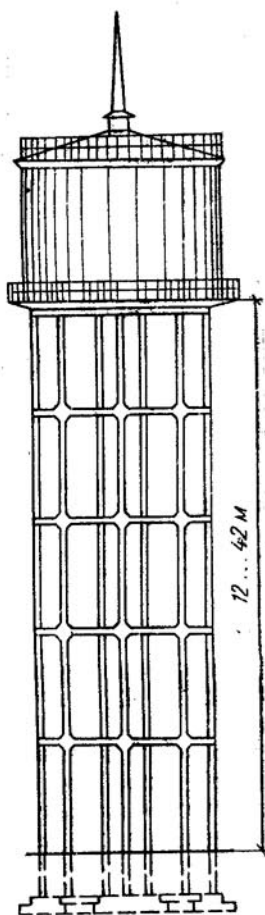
Водонапорная башня с железобетонной рамной опорой
